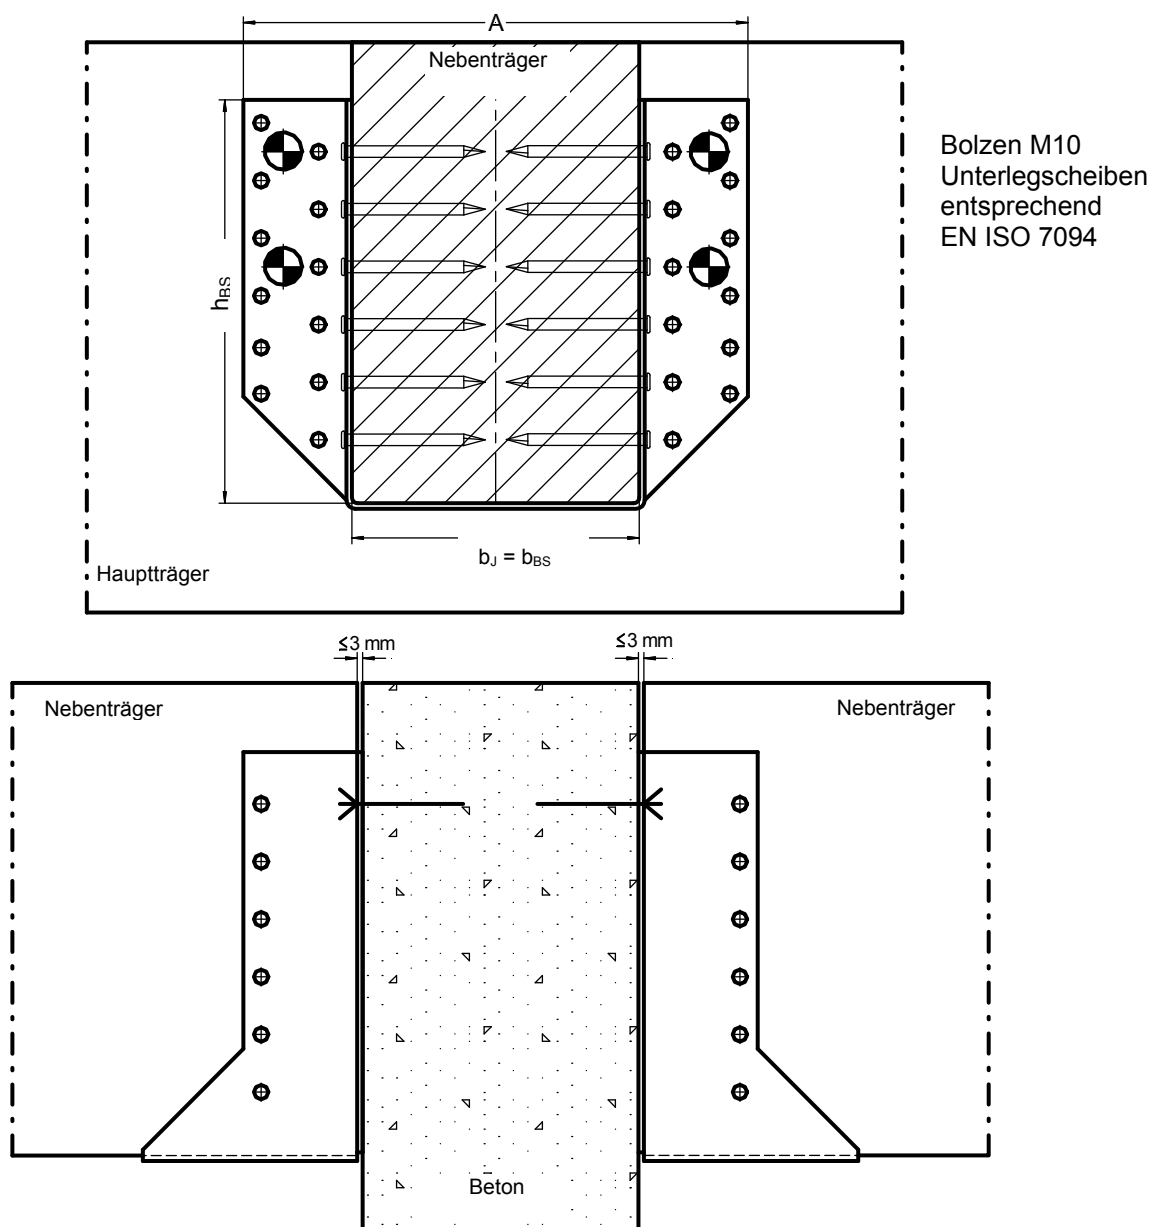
BB Balkenschuhe in Holz/Beton, Holz/Leichtbeton oder Holz/Stahl Verbindung mit Bolzen
